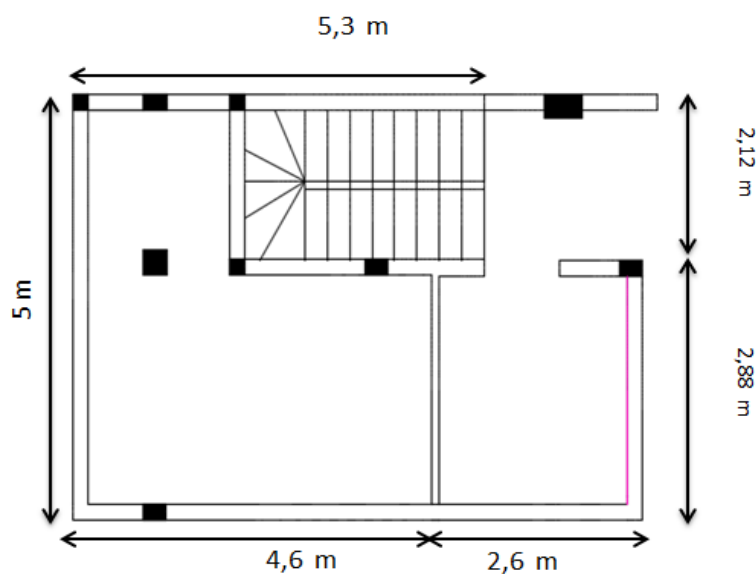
Reemplazo de ventanas exteriores por una construcción de ladrillo
